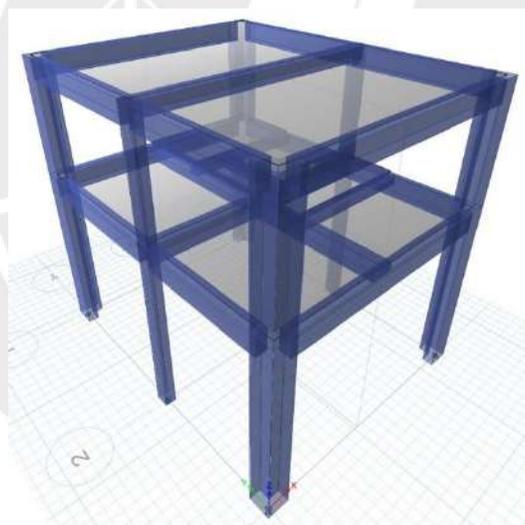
Modelamiento final en el ETABS. Fuente: Propia.
